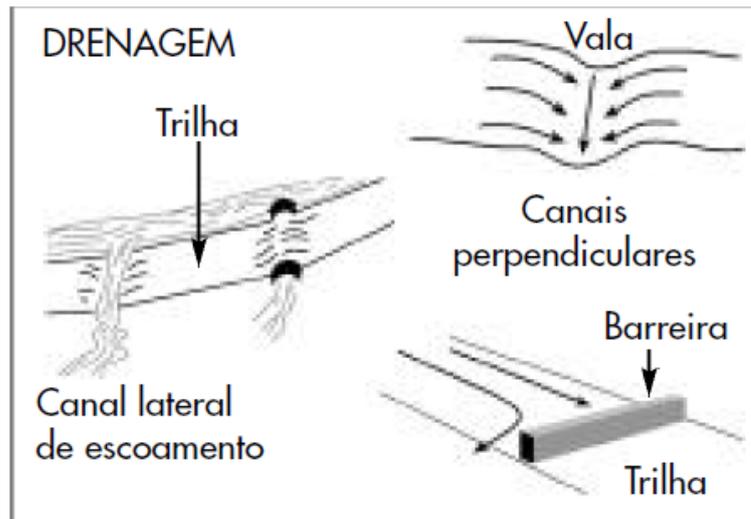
Exemplos de canais, valas e barreiras utilizados para o processo de drenagem.
